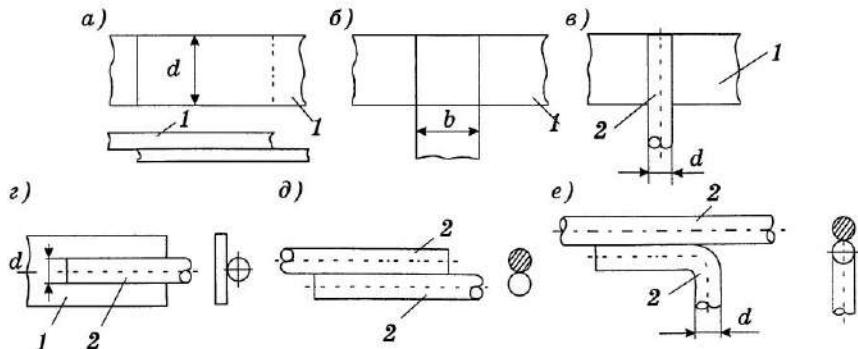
Соединение заземляющих проводников и горизонтальных заземлителей: а — продольное соединение проводников из полосовой стали; б — ответвление проводника из полосовой стали; в — ответвление проводника из круглой стали; г — продольное соединение проводников из полосовой и круглой стали; д — продольное соединение проводников из круглой стали; е — ответвление от проводника из круглой стали;
